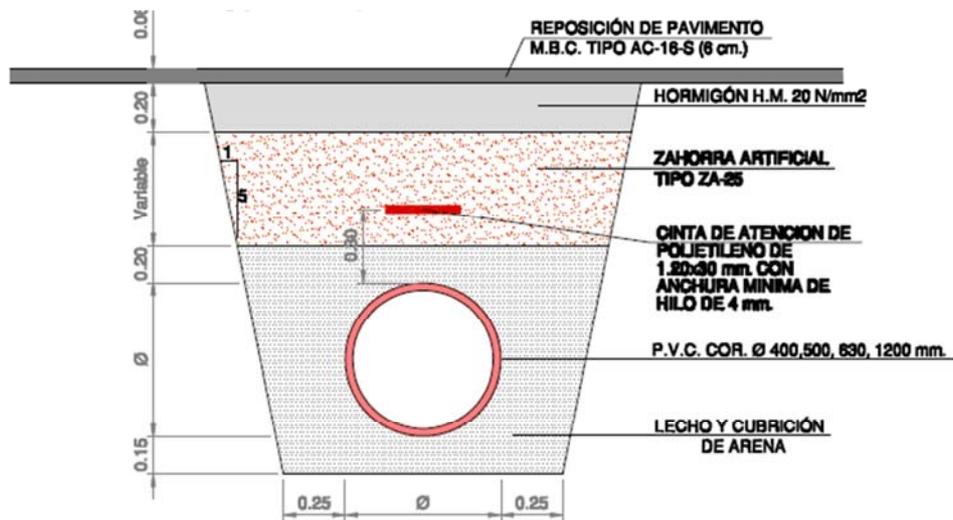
Sección transversal del proyecto para los colectores de conexión con el Tanque de Tormenta
